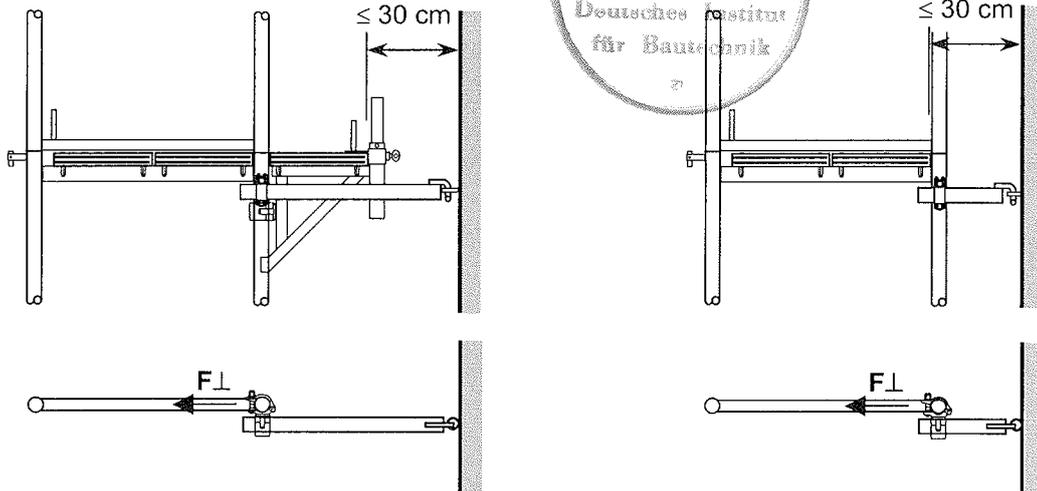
Höhenlage der Gerüsthalter bei Anschluss im „Knoten“.
